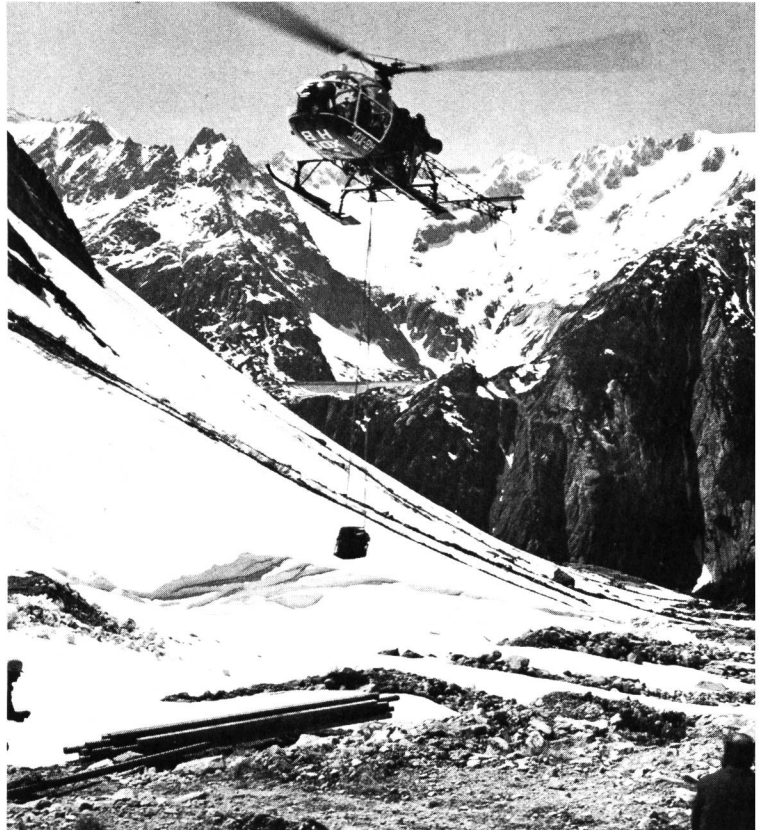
Helikopterschliessung der Baustelle Handeckfluh (Aufnahme vom 24. Mai 1974).
